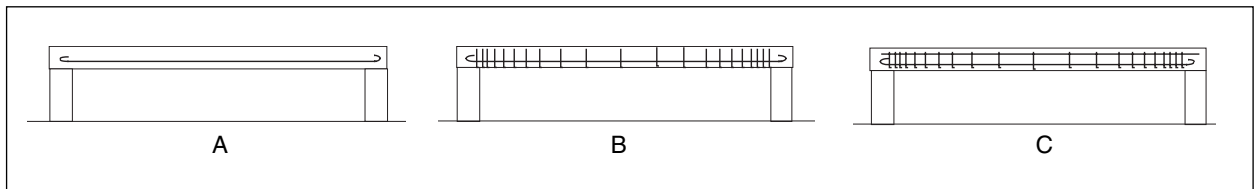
Ferrailage d'une poutre sur appuis libres.
